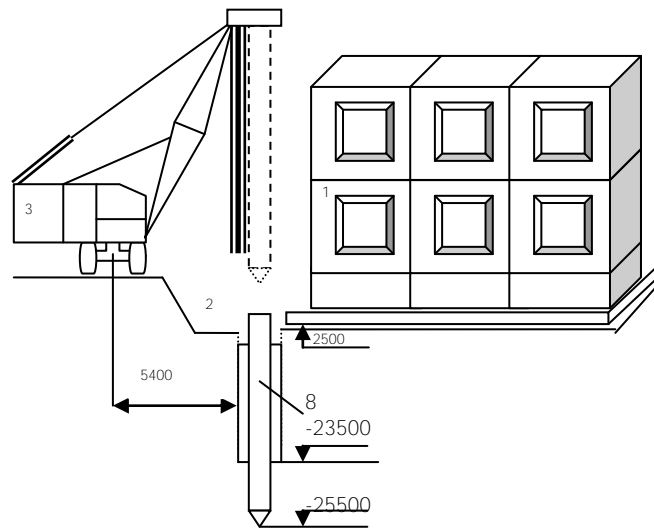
Монтаж стовбура палі: 1 - аварійний дев'ятиповерховий житловий будинок, 2 - траншея, 3 - кран, 5 - стоянка крана, 8 - паля
